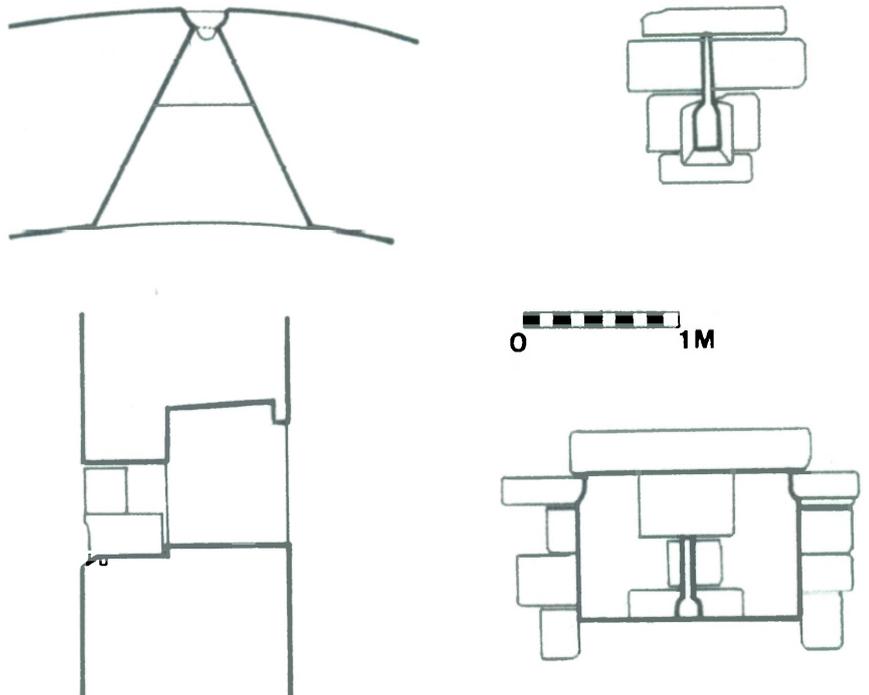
Tour sud-est , rez-de-chaussée, la canonnière : plan, coupe, vue extérieure et vue intérieure. Relevés de l'auteur.
